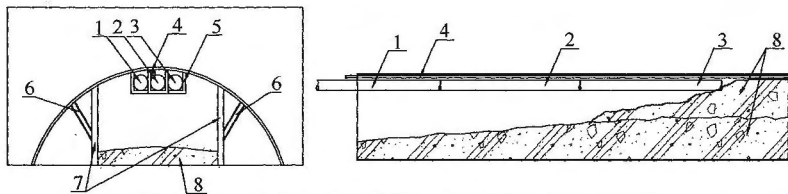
顶进钢管内混凝土浇筑设施布置示意图
